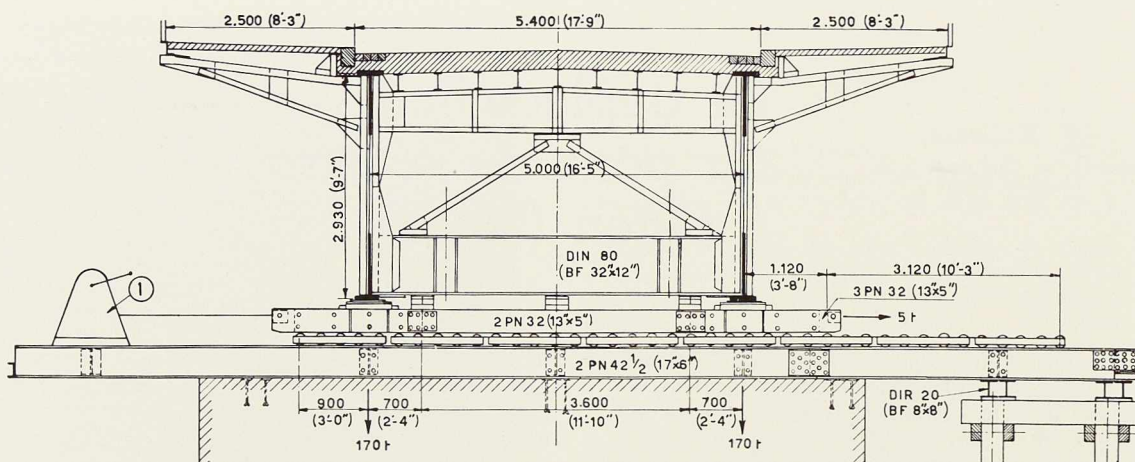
Coupe transversale du pont, posé sur les chariots.
